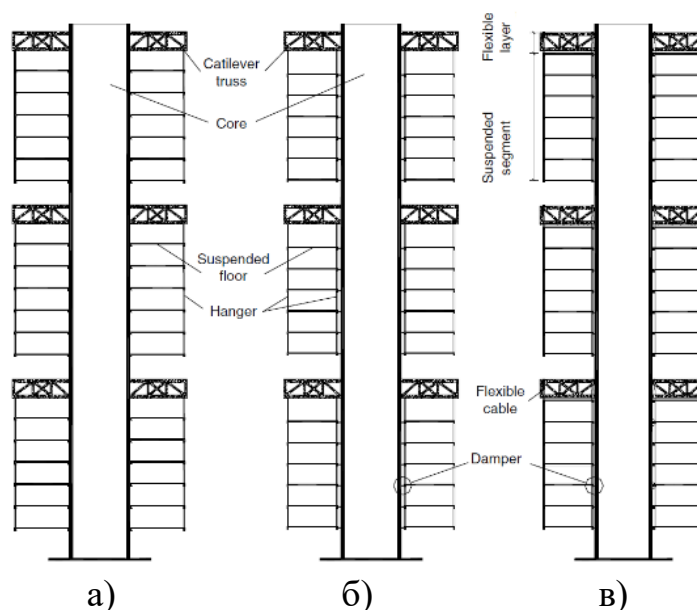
Подвесные конструкции: а) традиционная схема; б) ствольная система с подвесками вдоль ствола; в) здание с полугибкими подвесными системами
